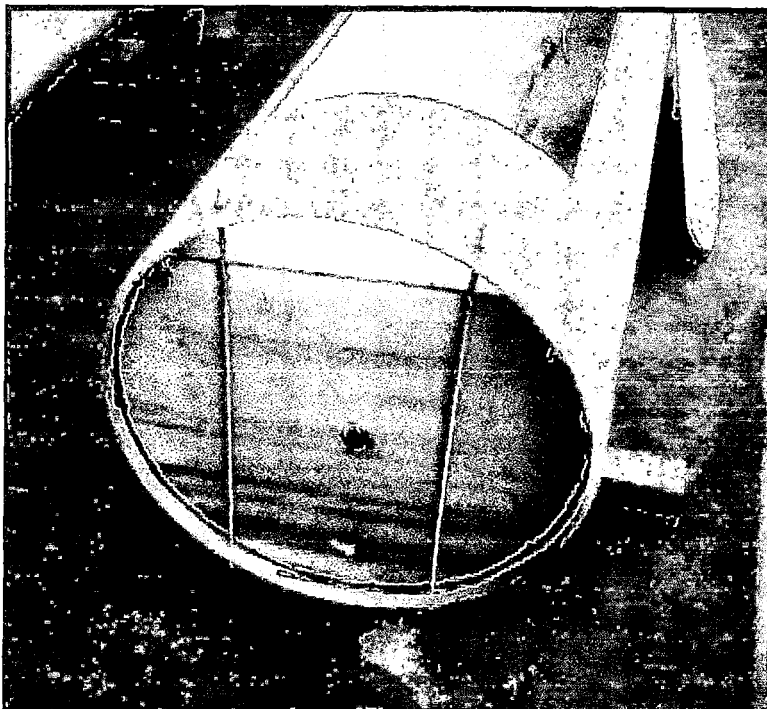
Colocación y refuerzo de las tapas laterales.
